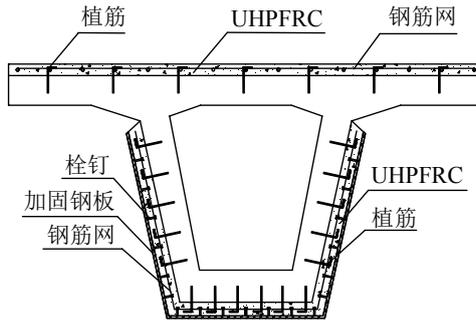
装配式预应力混凝土组合箱梁抗剪加固构造示意
